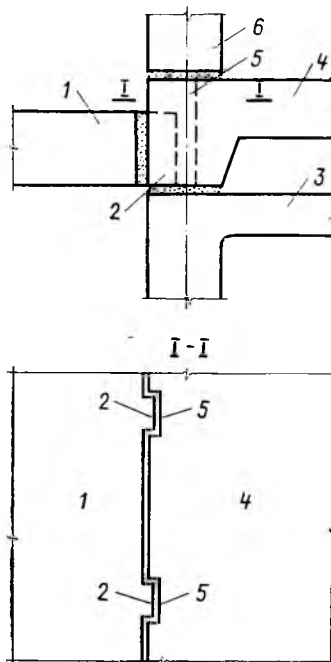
Контактный стык с опиранием перекрытия на опорные консоли
